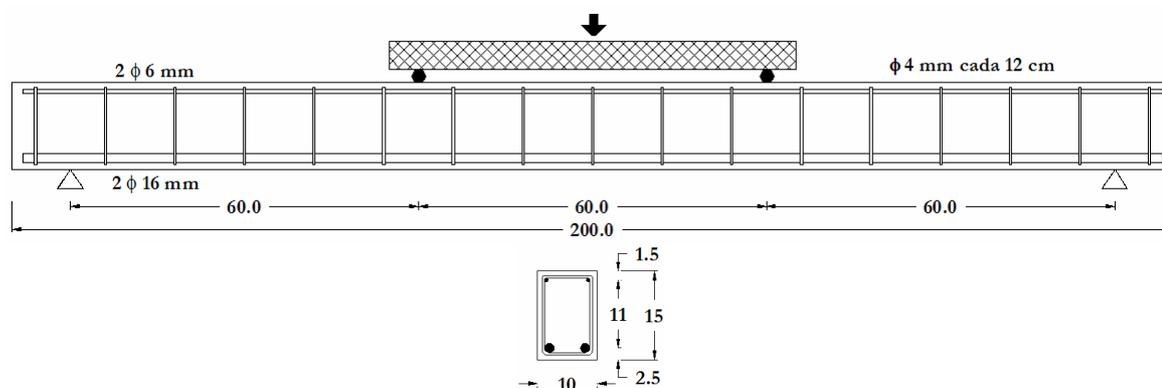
Detalhamento da viga de Kovács e Balázs (2003) (vigas KB-0.0, KB-0.5 e KB-1.0).
